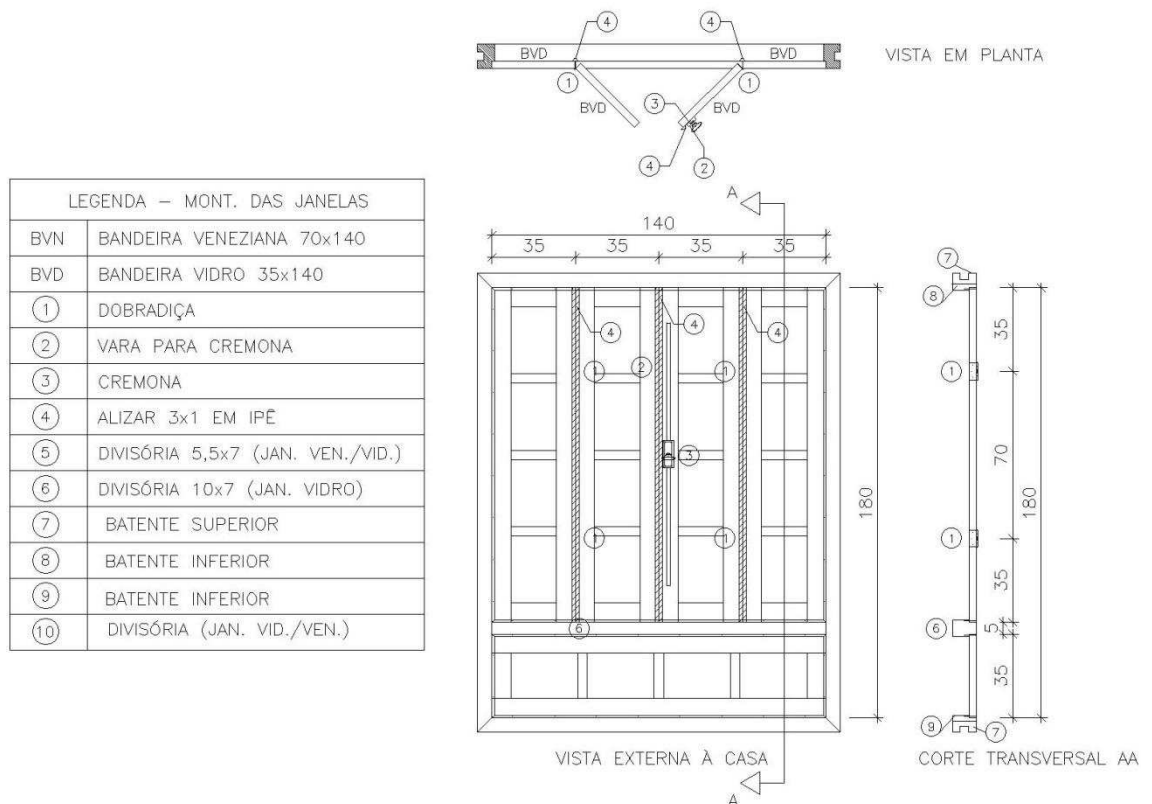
Detalhe de montagem de janela com caixilho para vidro, de duas bandeirolas pivotantes centrais, abrindo para dentro, e duas bandeirolas fixas nas laterais.
